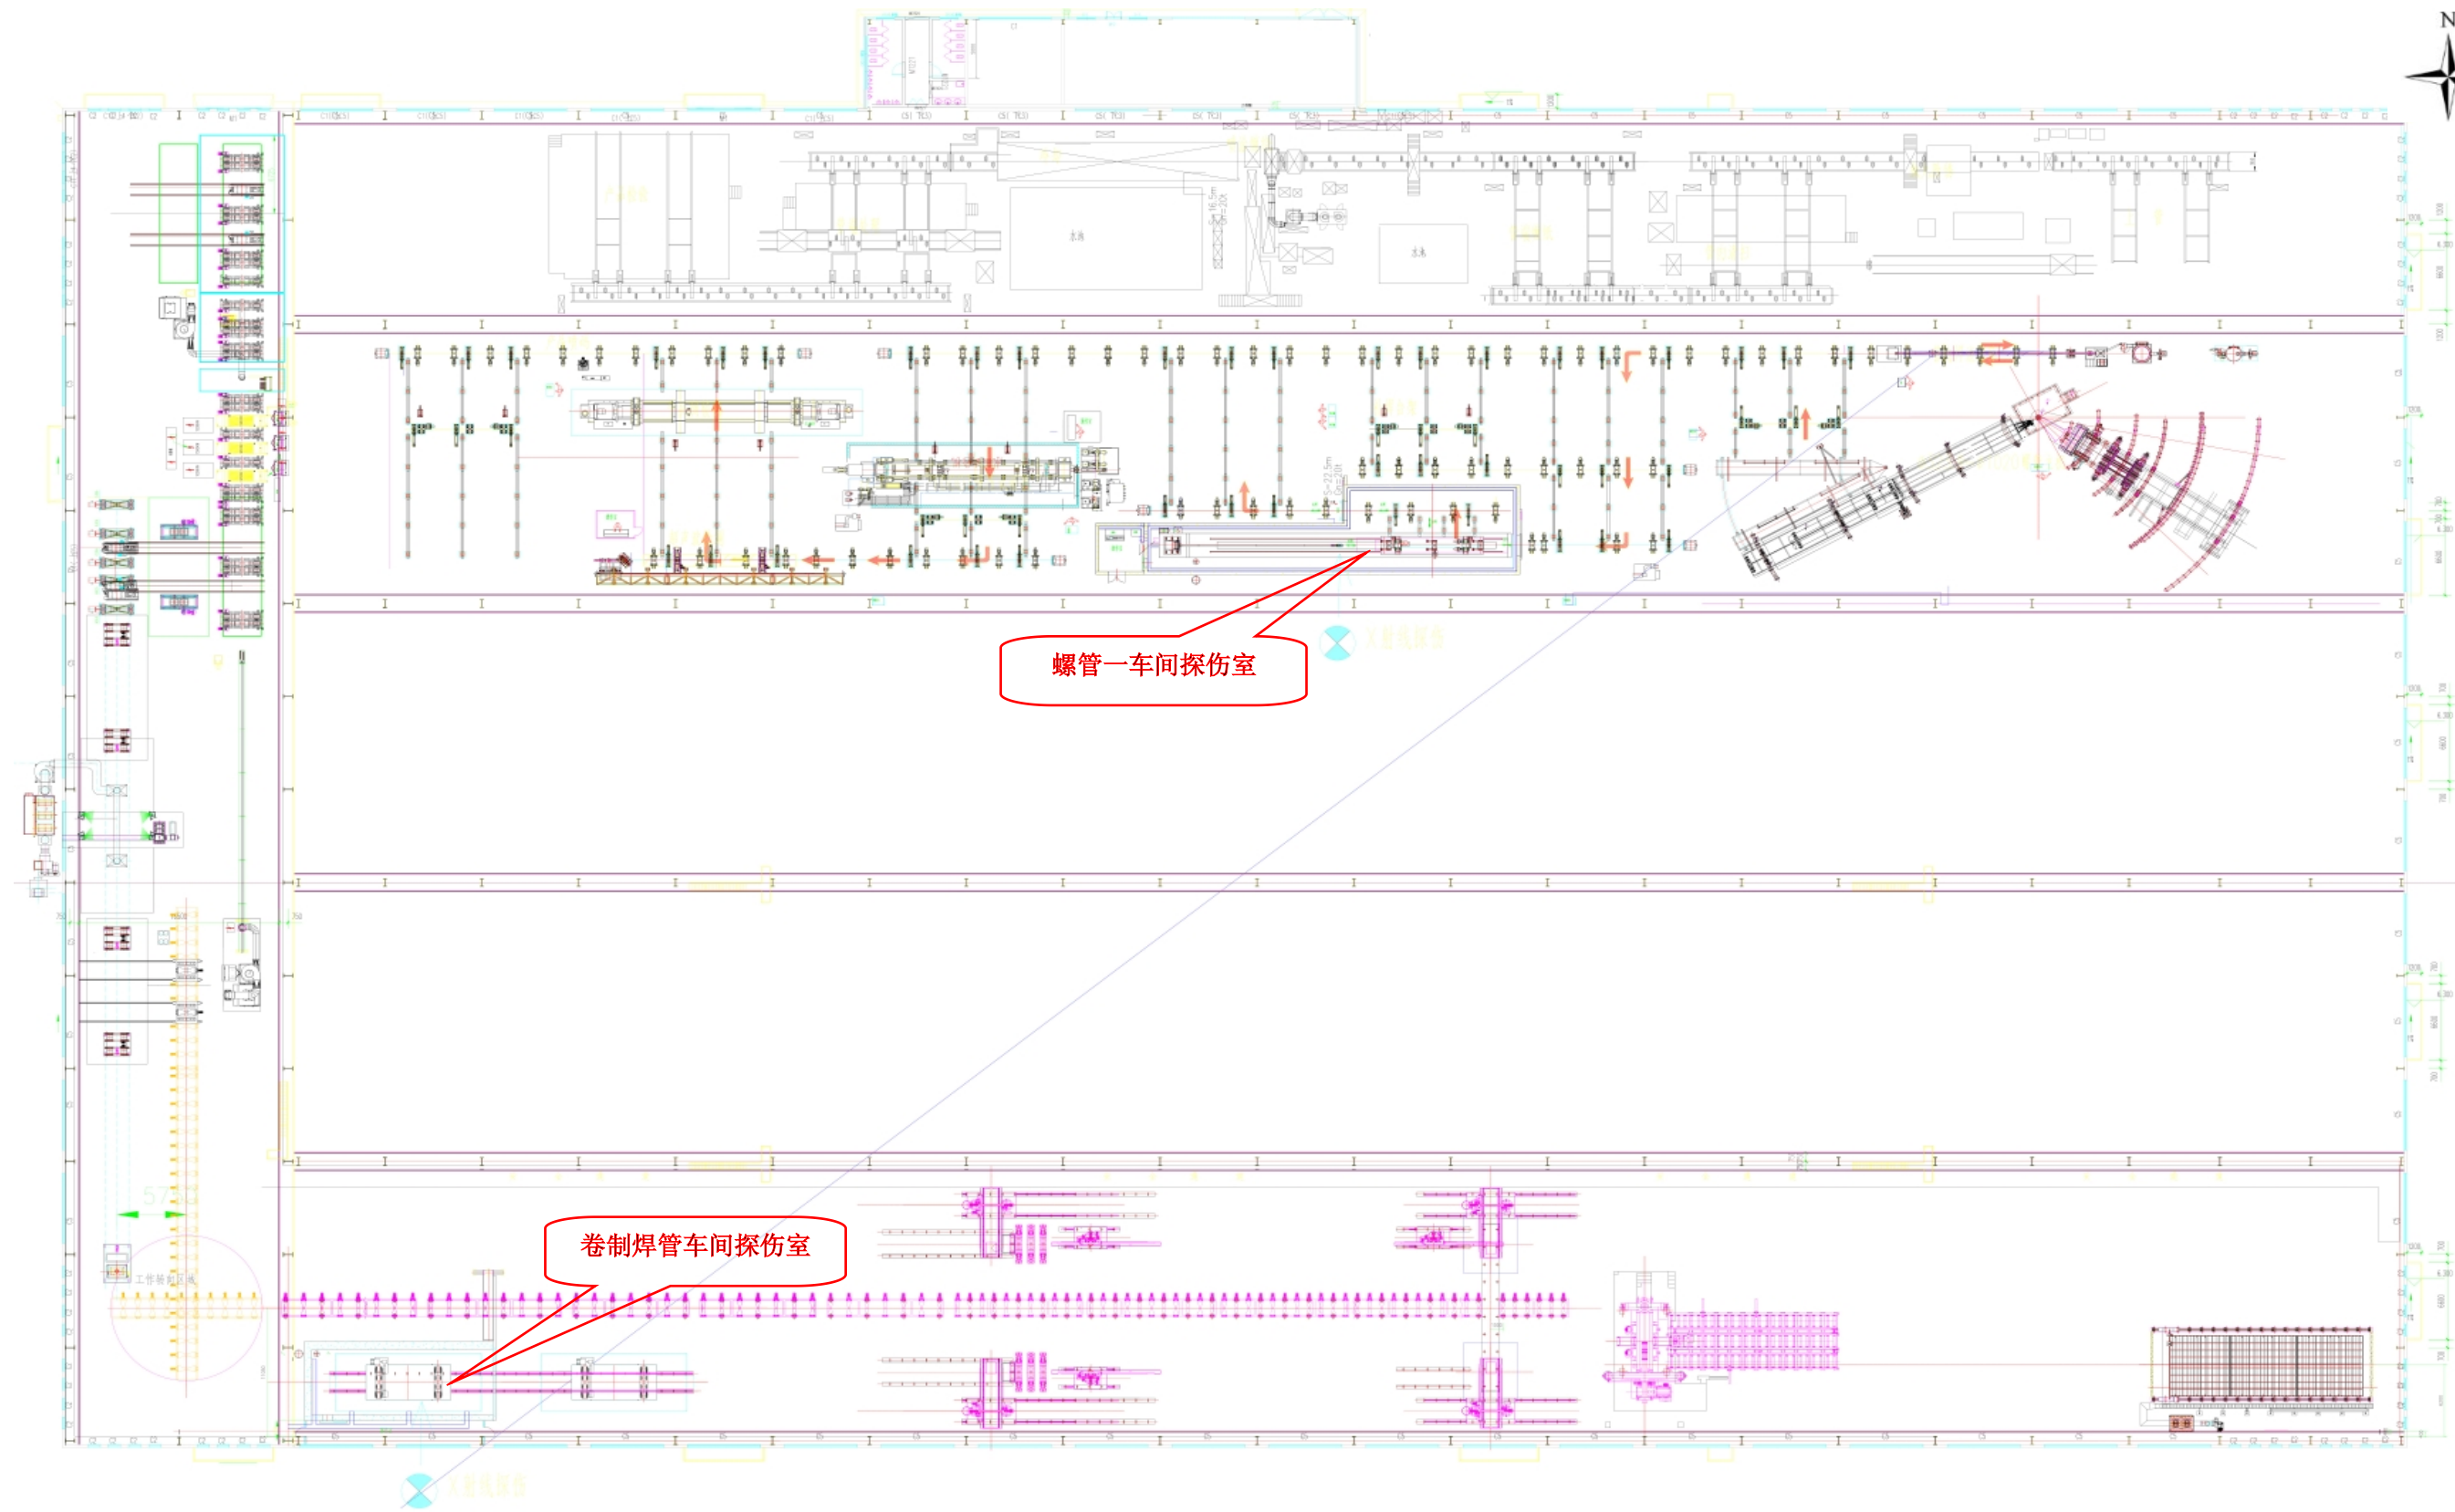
浙江金洲管道工业有限公司厂区平面布置图
